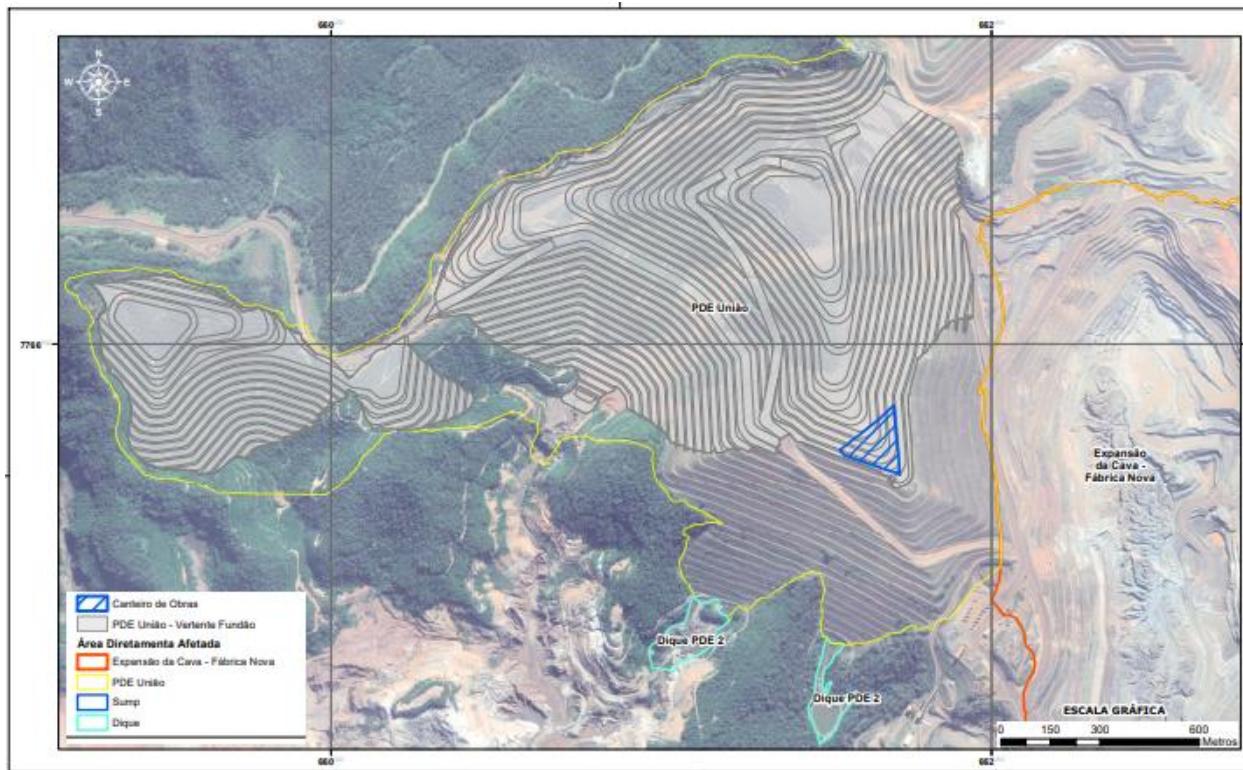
Área prevista para a instalação do Canteiro de Obras para a vertente Fundão. Fonte: RCA VALE, 2018.
